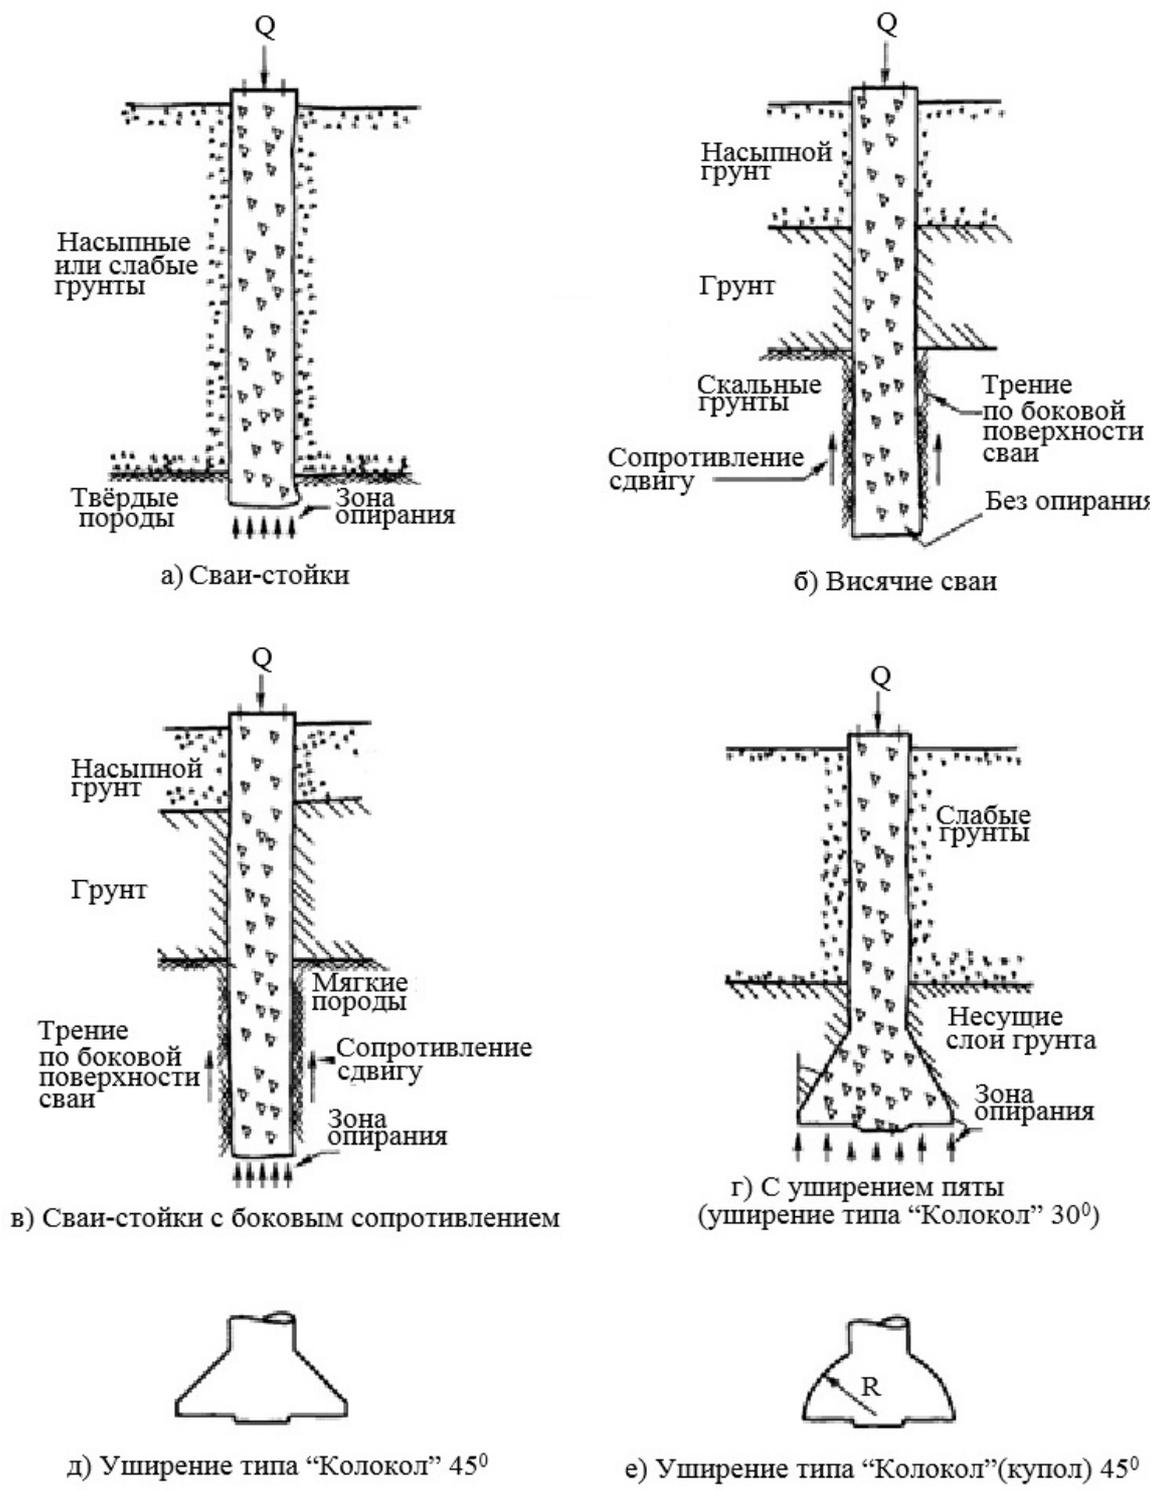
Типы буронабивных свай по способу опирания в грунтовом основании
